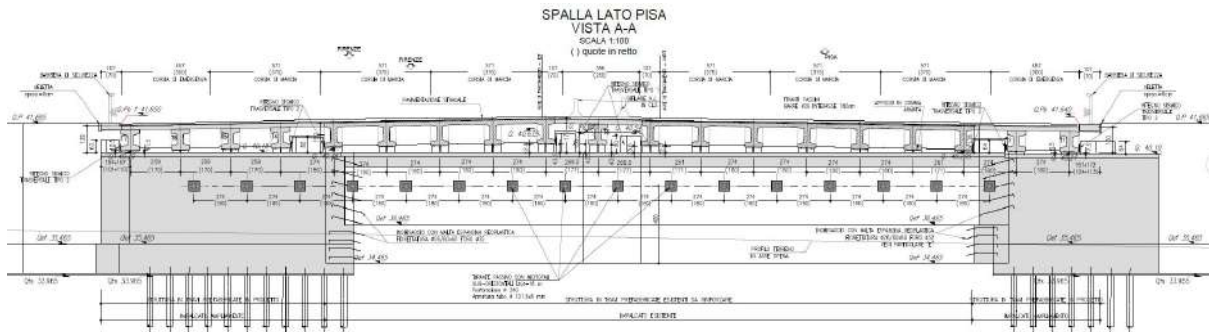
Ponte sul F. Reale. Sezione trasversale.
